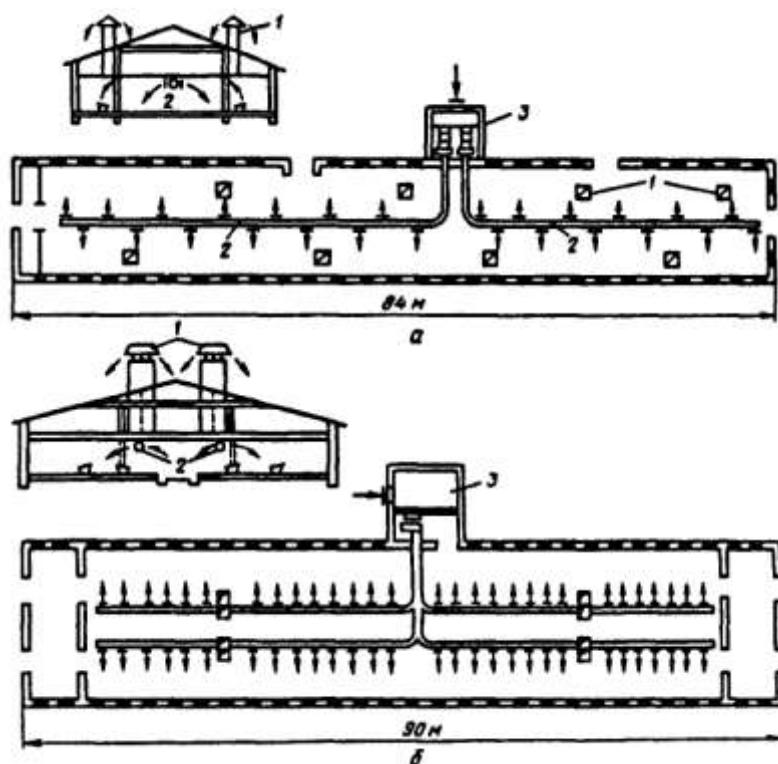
Схема вентиляции коровника при ширине помещения: а - 12 м; б - 18 м; 1 - вытяжные шахты; 2 - приточные воздуховоды; 3 - вентиляционная камера
